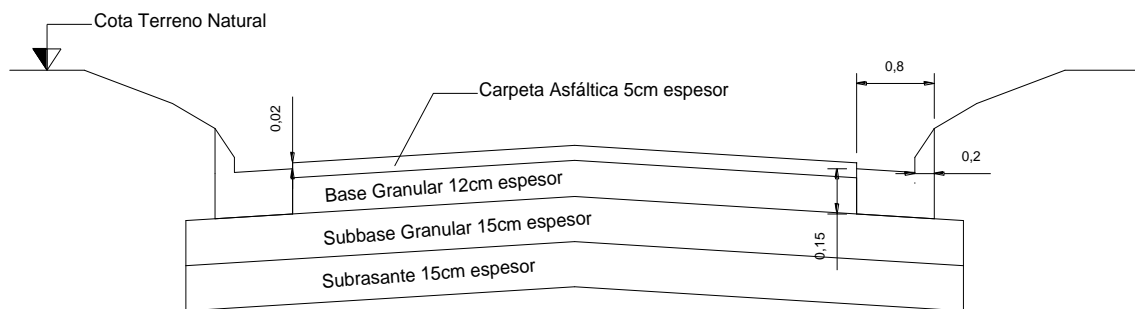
Corte Esquemático del Paquete Estructural
